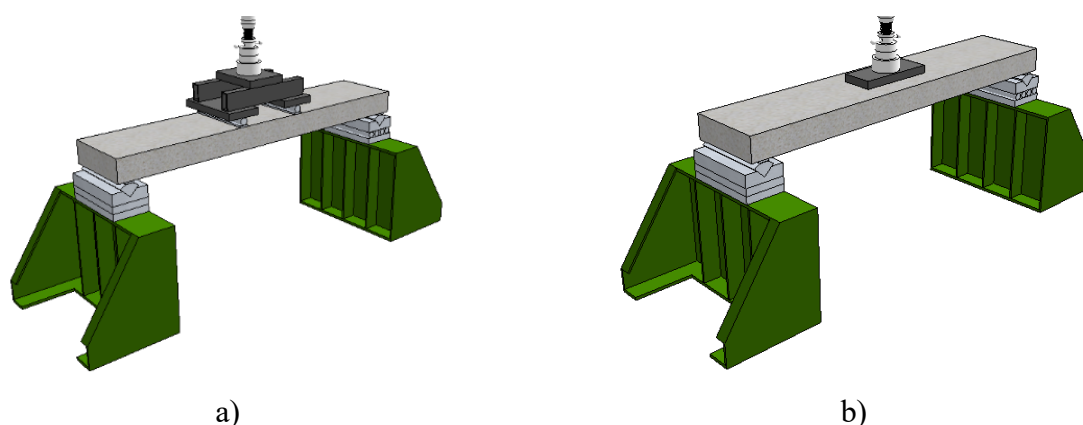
Modification du type de chargement, a) 4 points, b) Plaque
